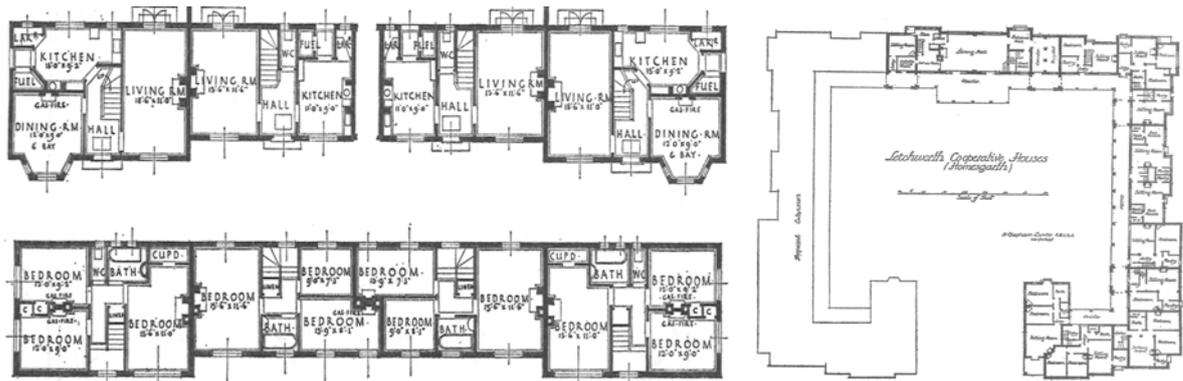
Grundriss einer Reihenhausezeile Erdgeschoss oben und Obergeschoss unten
